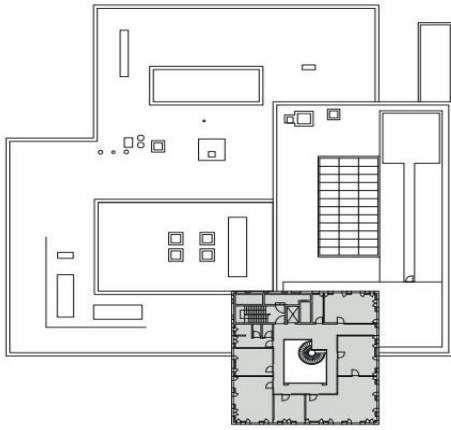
Plan 3eme Niveau (Source : www.zsw-bw.de)
